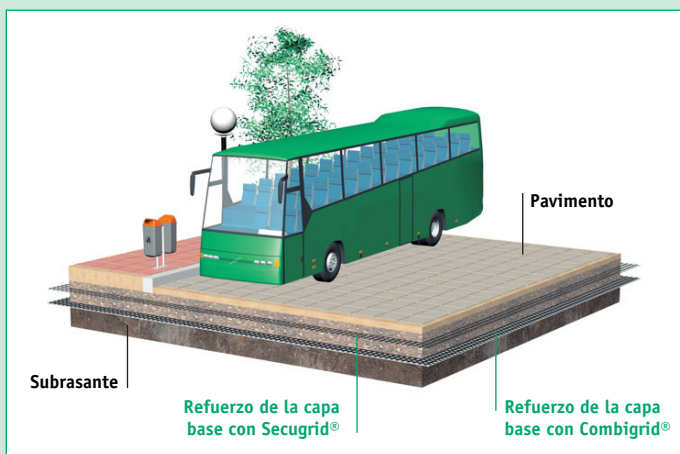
Reforzamiento de la capa base para las cargas grandes en suelos con baja capacidad portante.
